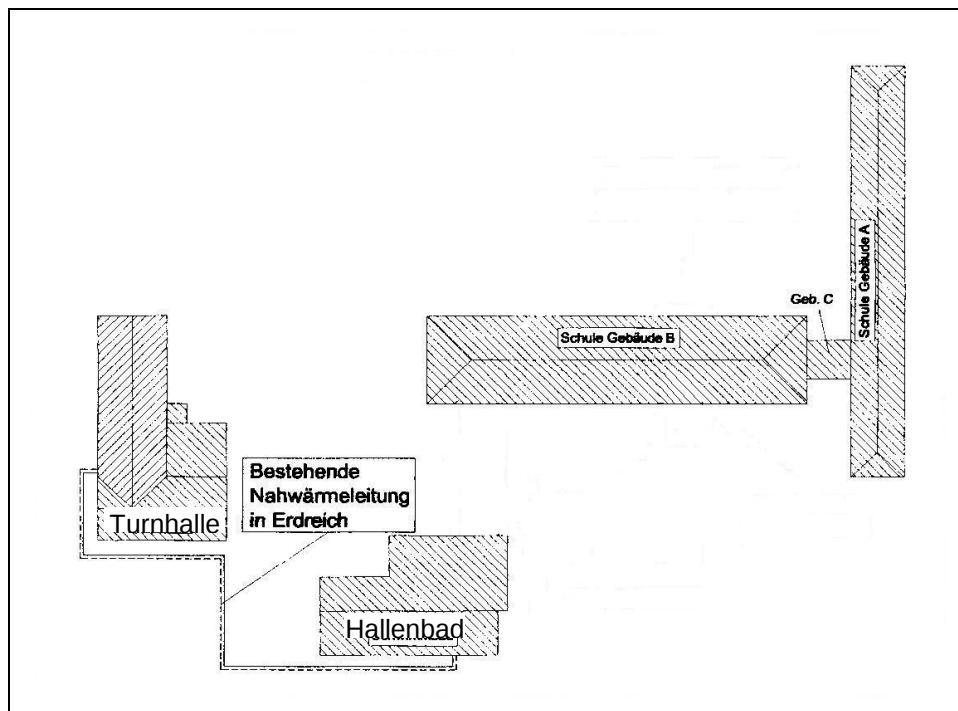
Lageplan der Konrad-Adenauer-Schule
